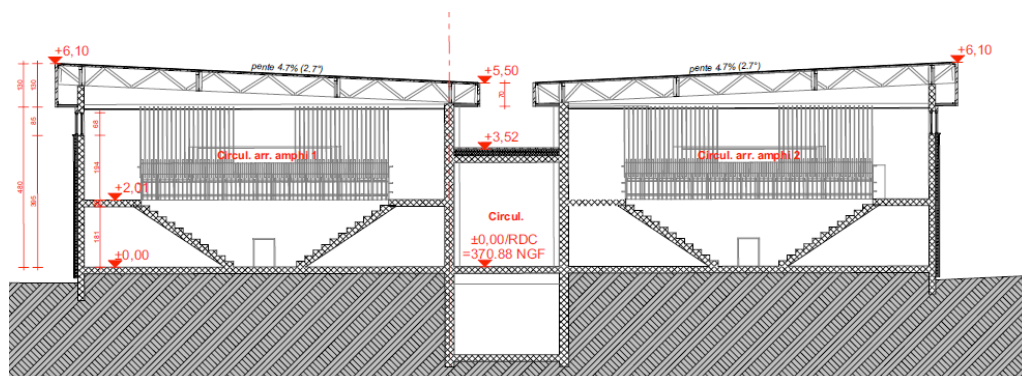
Coupe BB transversale du bloc B du bâtiment F (sans échelle)
